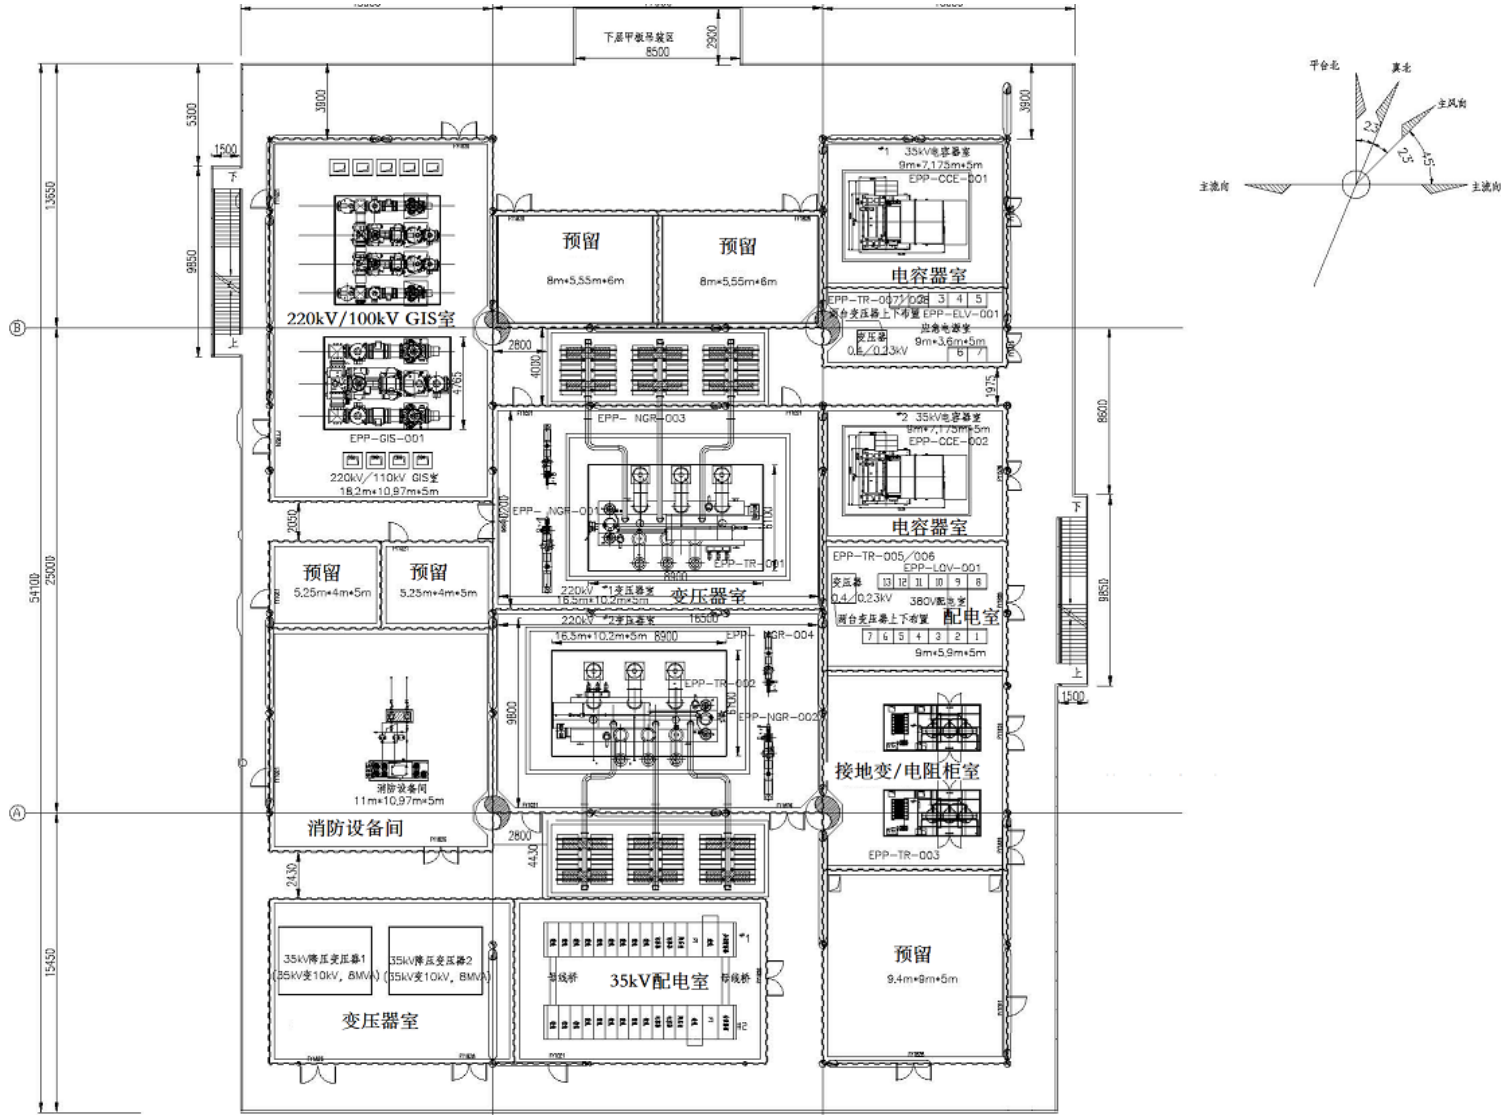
QHD32-6 EPP 平台下层甲板平面布置图
